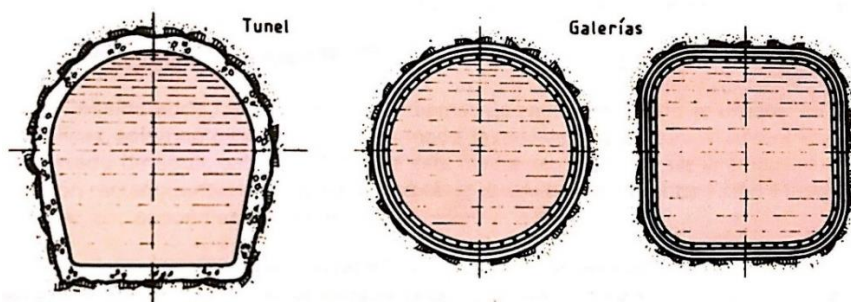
Secciones habituales en túneles y galerías. [19]
